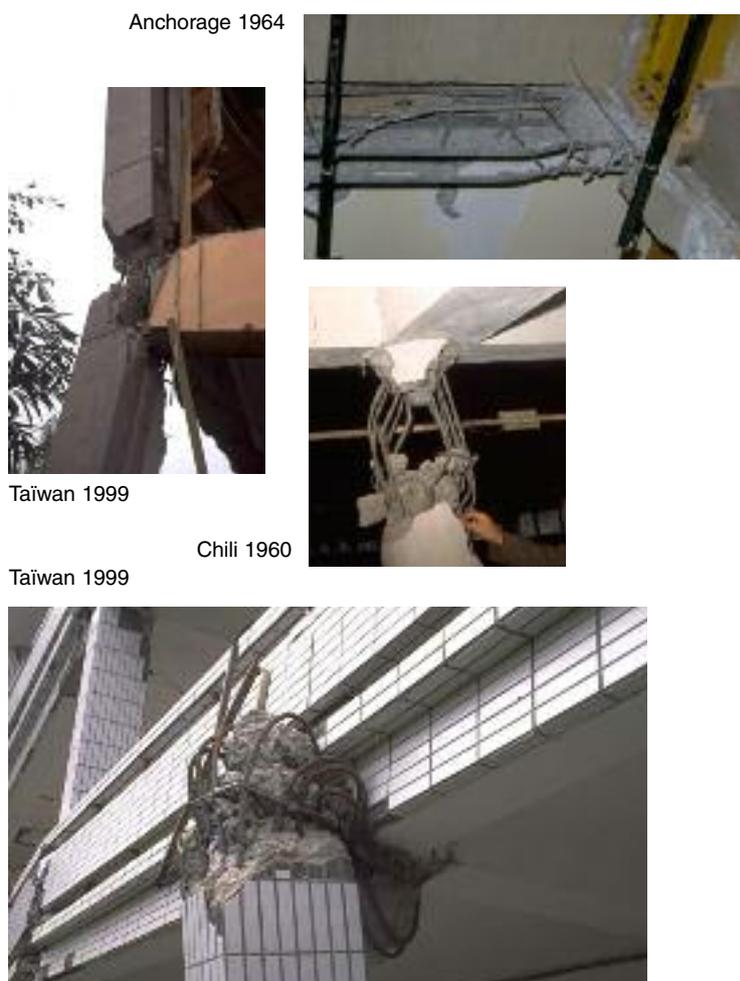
Éclatement des zones critiques dans les poutres, poteaux et nœuds
